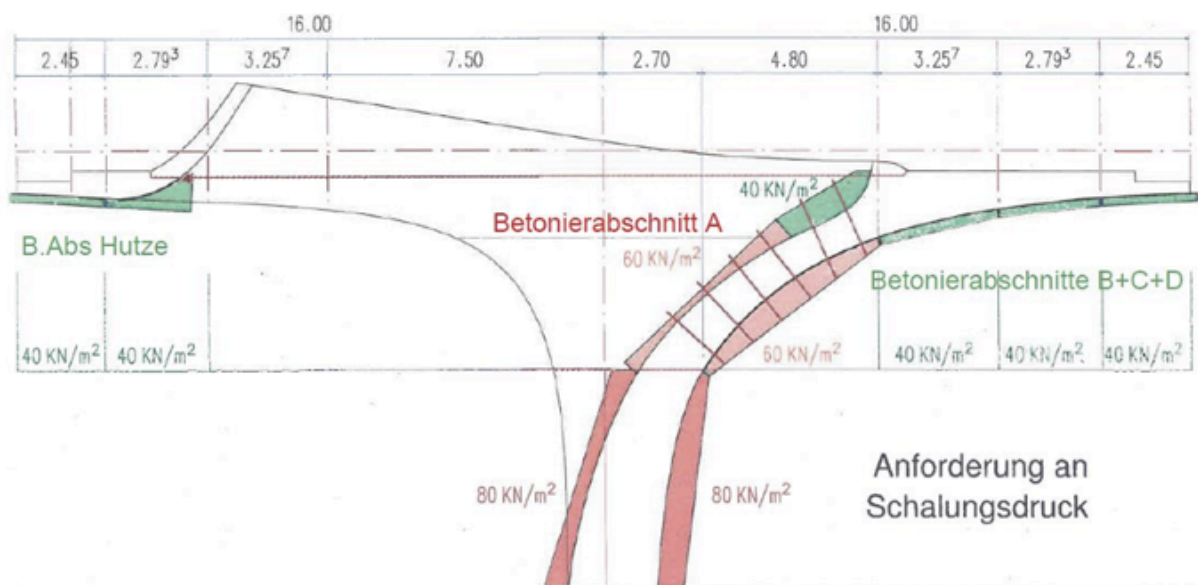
Frischbetondrücke und Betonierabschnitte der Kelche, aus [1]
